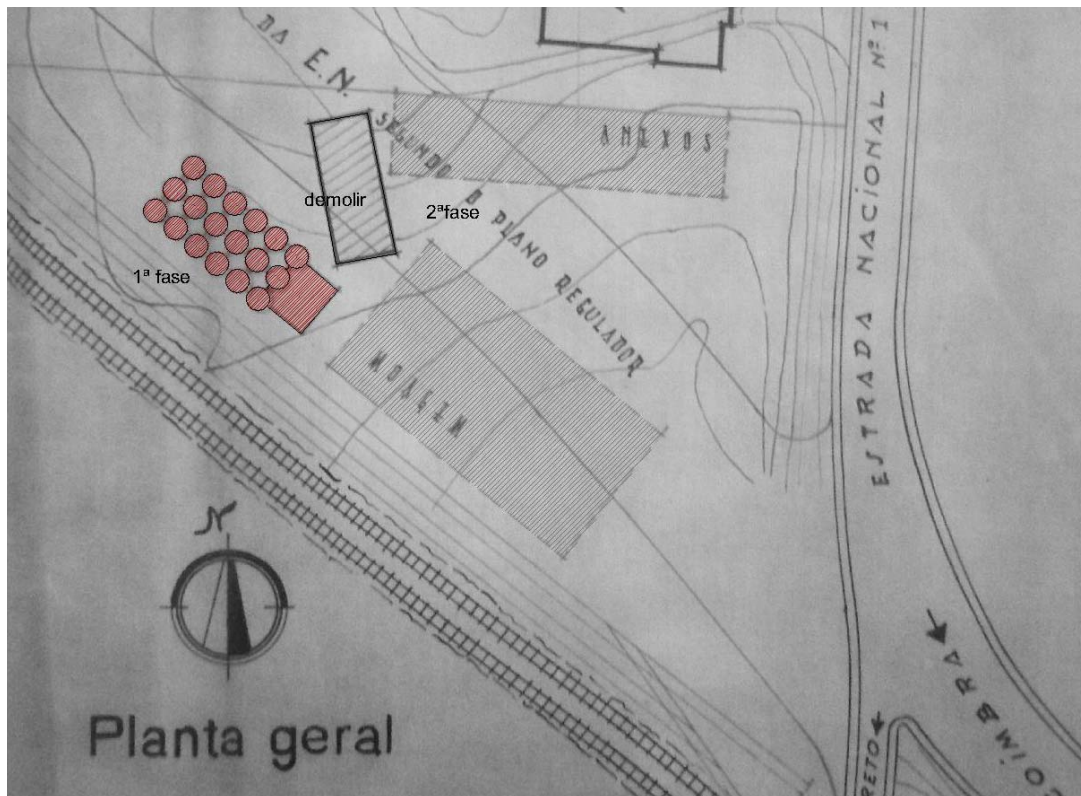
| Planta de implantação do anteprojeto e fases de construção
